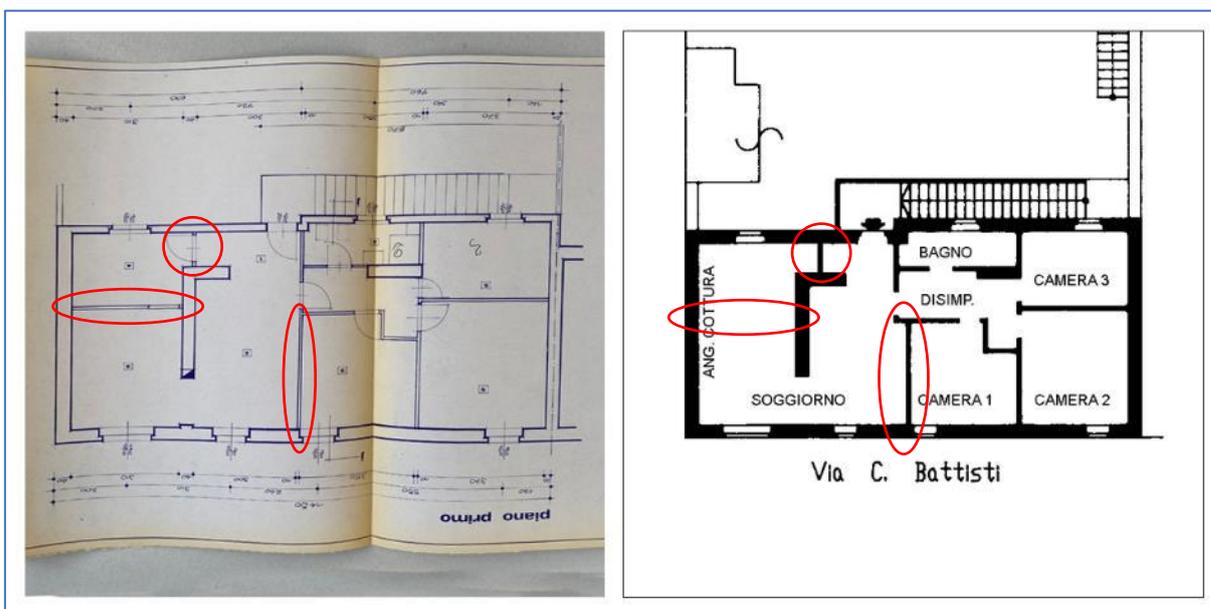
confronto tra stato autorizzato e stato di fatto rilevato
